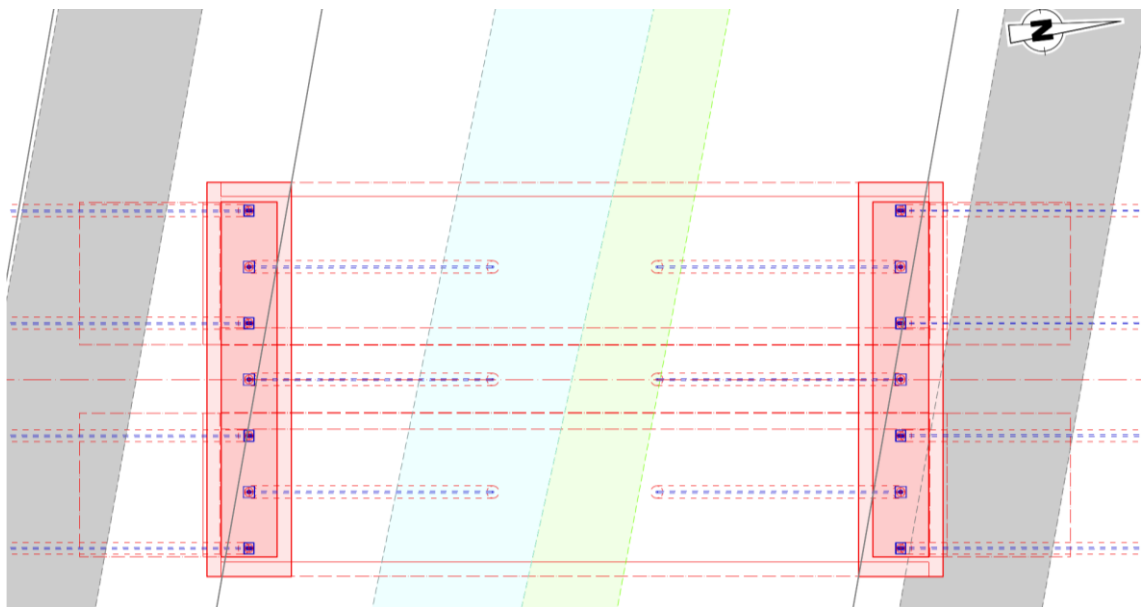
Grundriss der Fundamente mit alternierender Neigung der Pfähle zur Innen- bzw. Aussenseite
